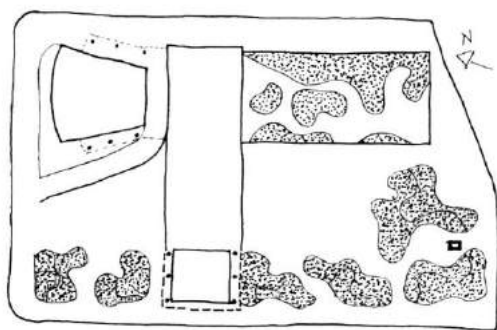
Planta baixa esquemática dos jardins do térreo do MES. Fonte: Desenho da Autora
